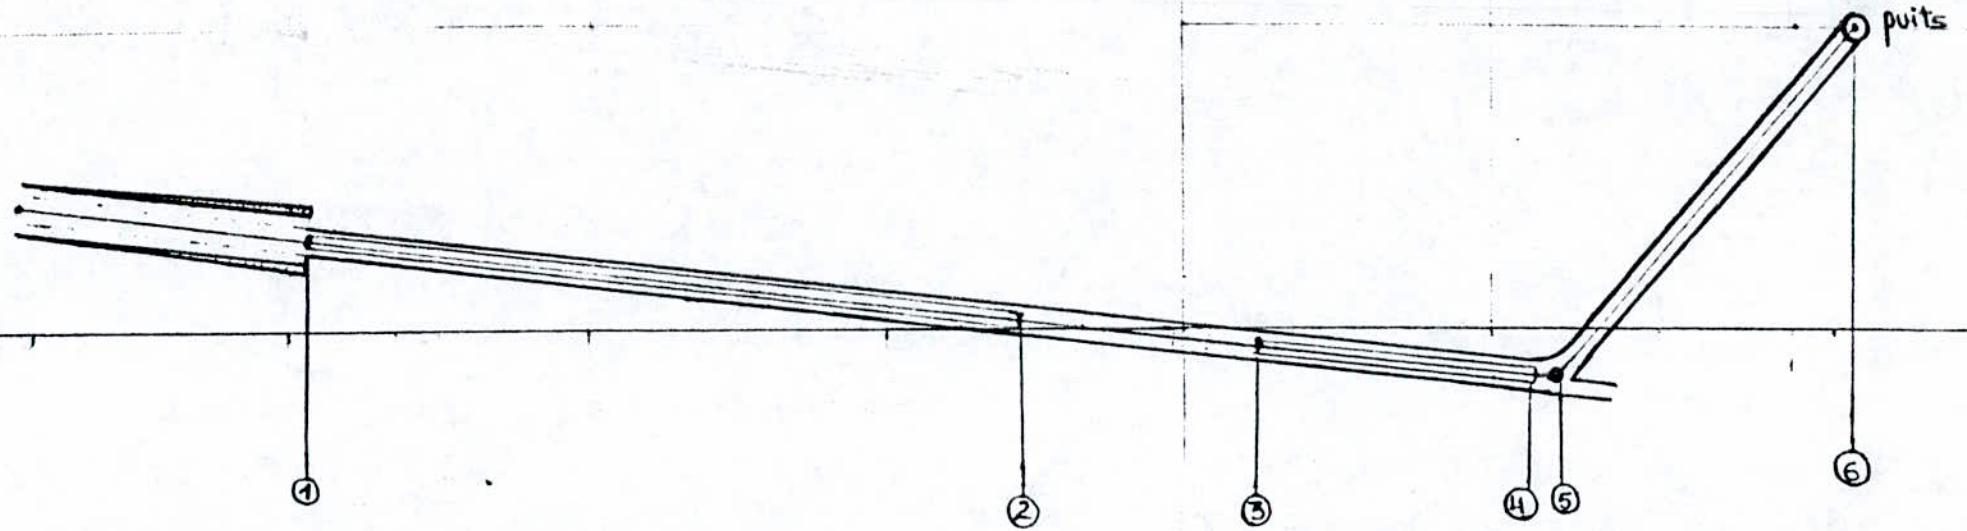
PLAN DES TRAVAUX D'OUVERTURES
